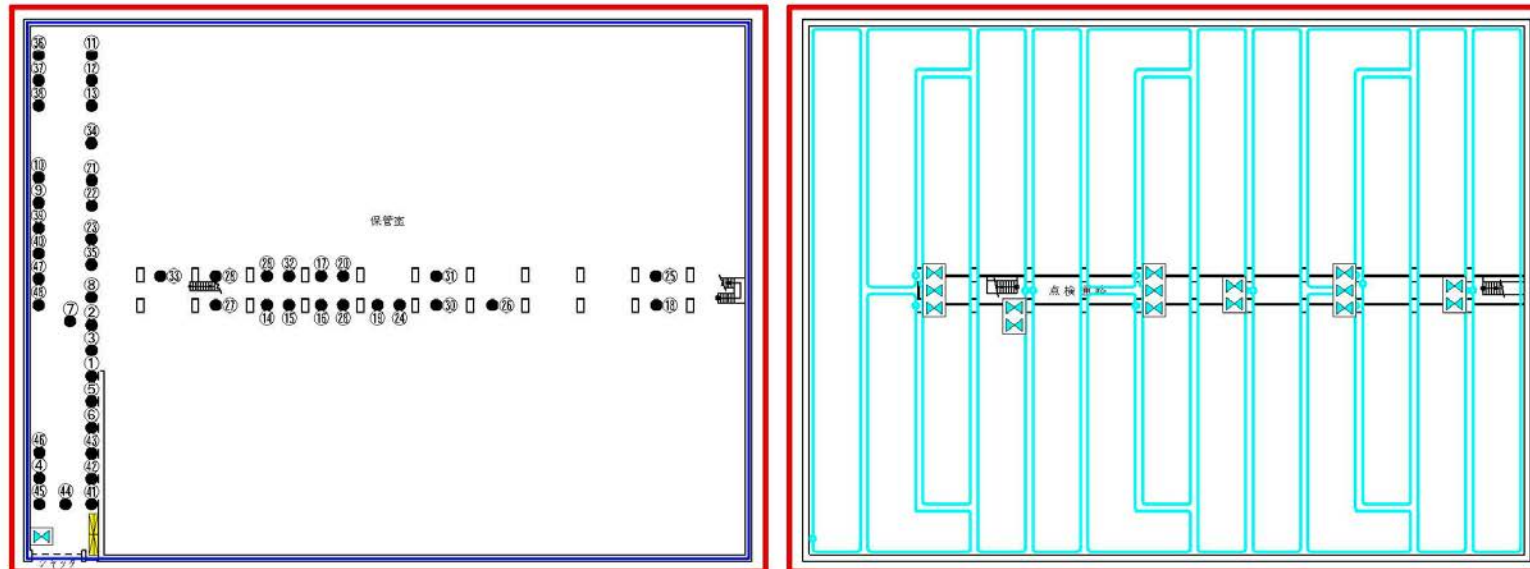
固体集積保管場 I 平面図及び可燃物配置図
